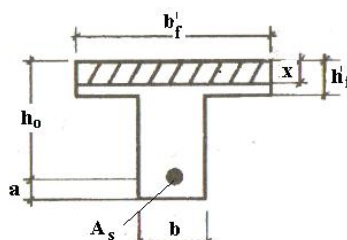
Расчетное сечение при расчете на пролетный момент
